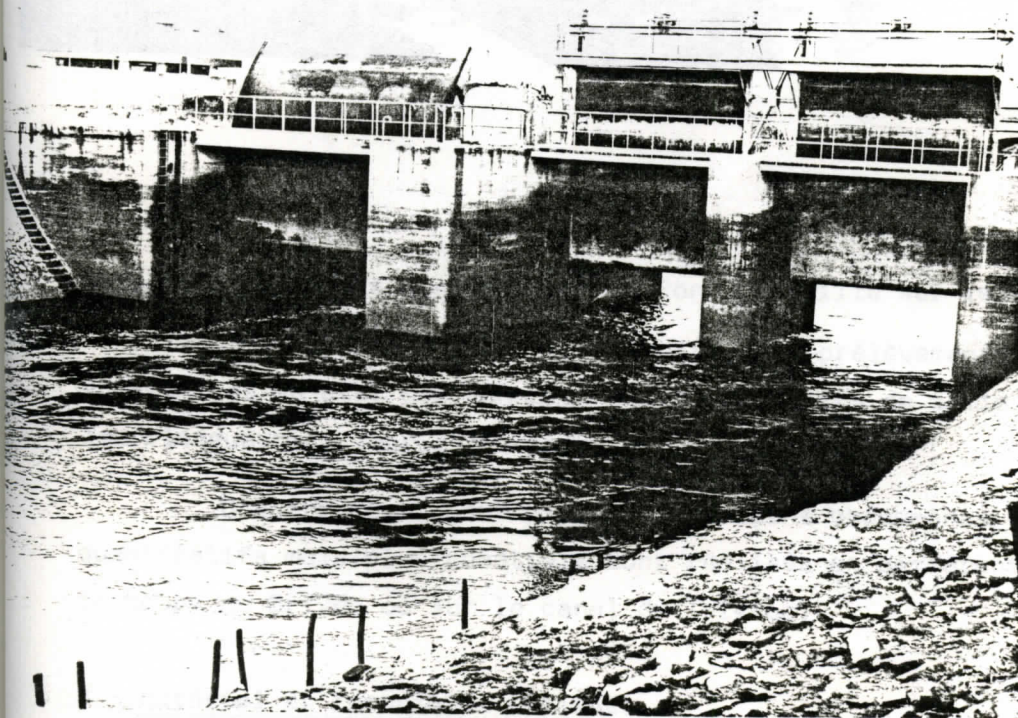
Vue aval des vannages de Méan sur le Brivet.
